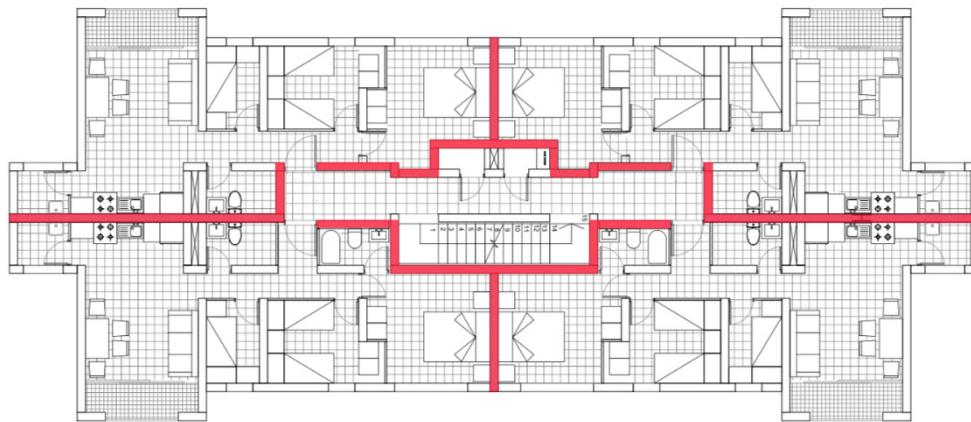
planta tipo edificio 6 pisos. Fuente: elaboración propia
